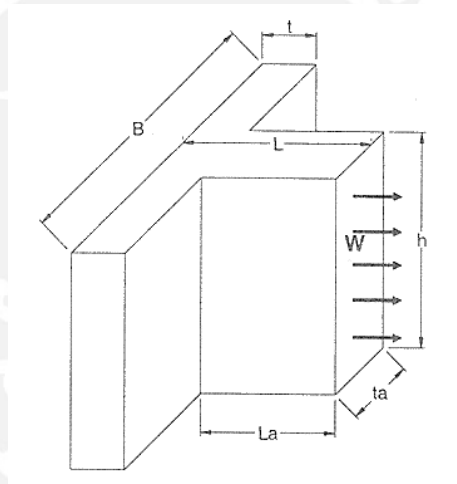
Fuerzas paralelas al muro de arriostre (Tejada, 2001)
